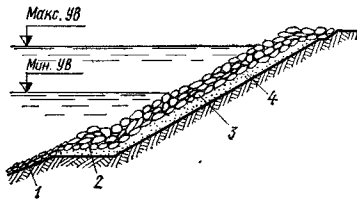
Крепление каналов каменной наброской: 1 — облегченное крепление; 2 — упорная призма; 3 — наброска камня; 4 — подготовка или обратный фильтр
